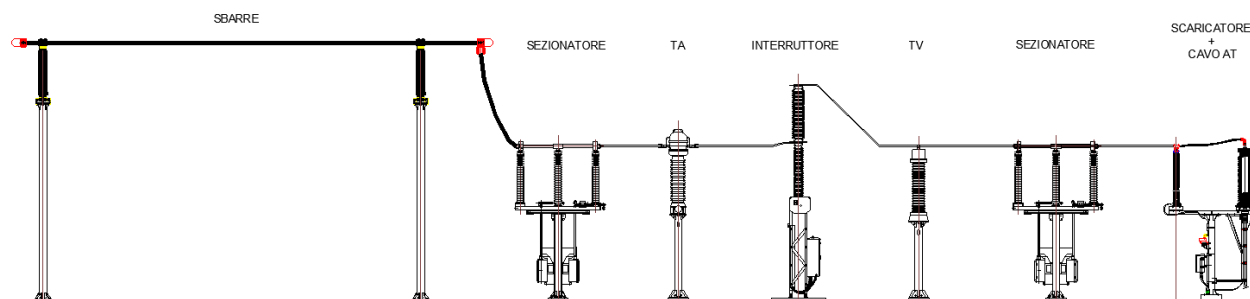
Sezione Longitudinale elettromeccanica stalli AT 150kV (SSE Utente)
